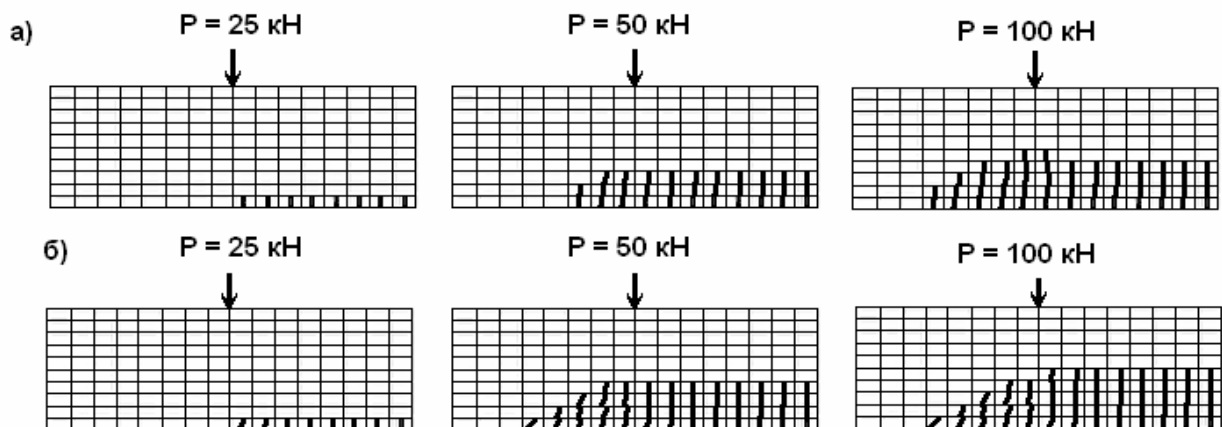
Трещинообразование в балках: а) без поперечного армирования; б) с поперечным армированием
